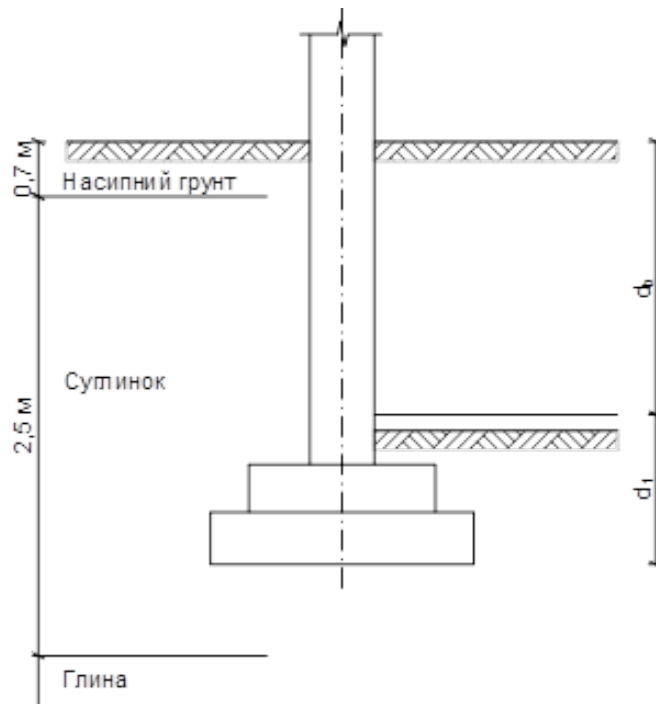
Схема розміщення фундаменту у ґрунті
